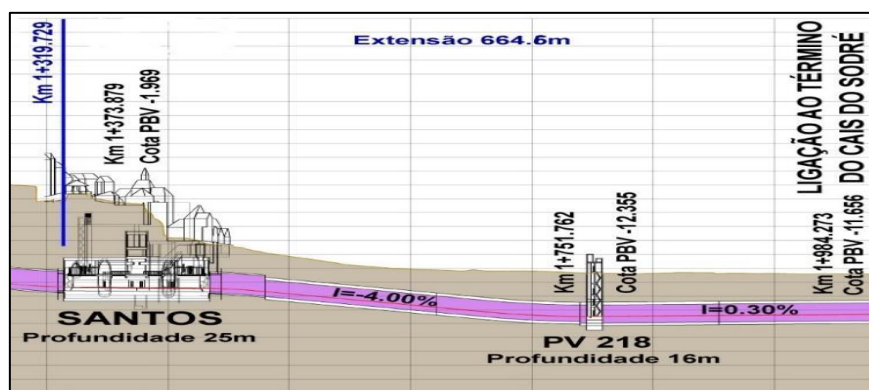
Traçado do Lote 2 em Perfil Longitudinal
